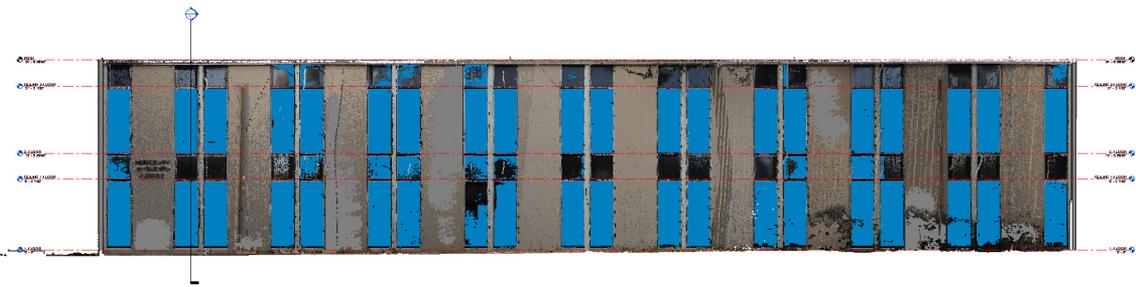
Fachada posterior. Fonte: Elaborado pelos autores.
